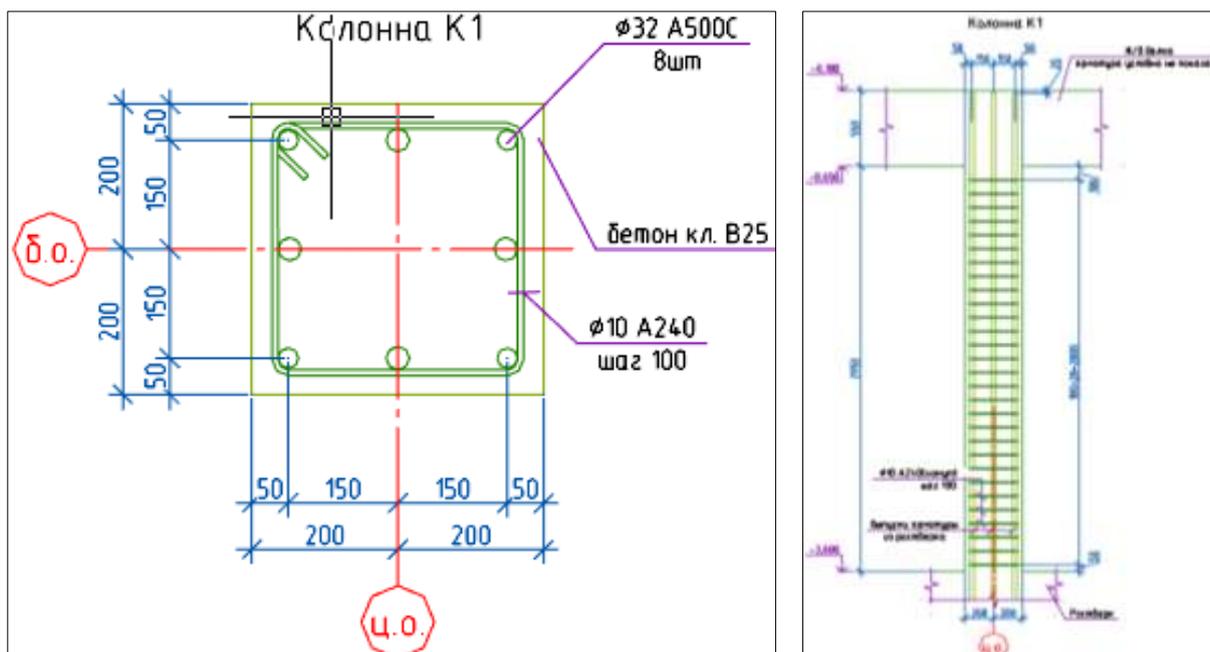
Принципиальные схемы армирования колонн квадратного поперечного сечения на типовом этаже
